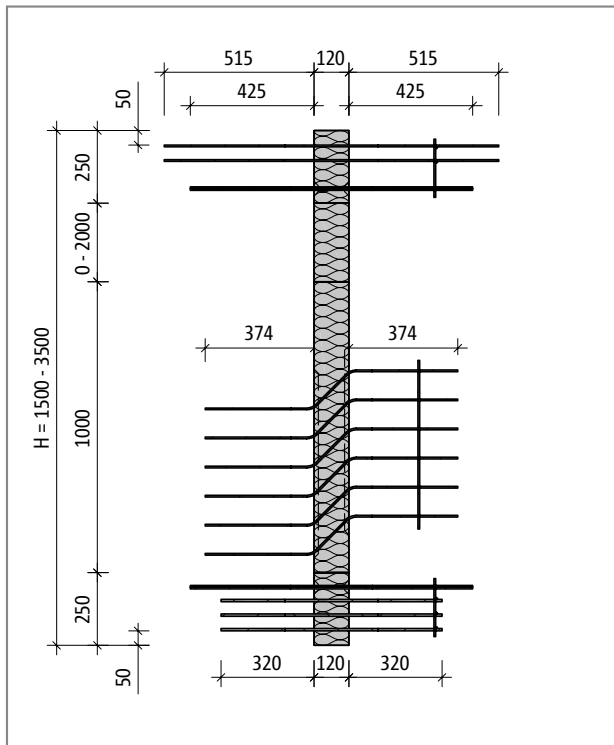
Schöck Isokorb® XT Typ W-M1 bei R0: Produktschnitt
